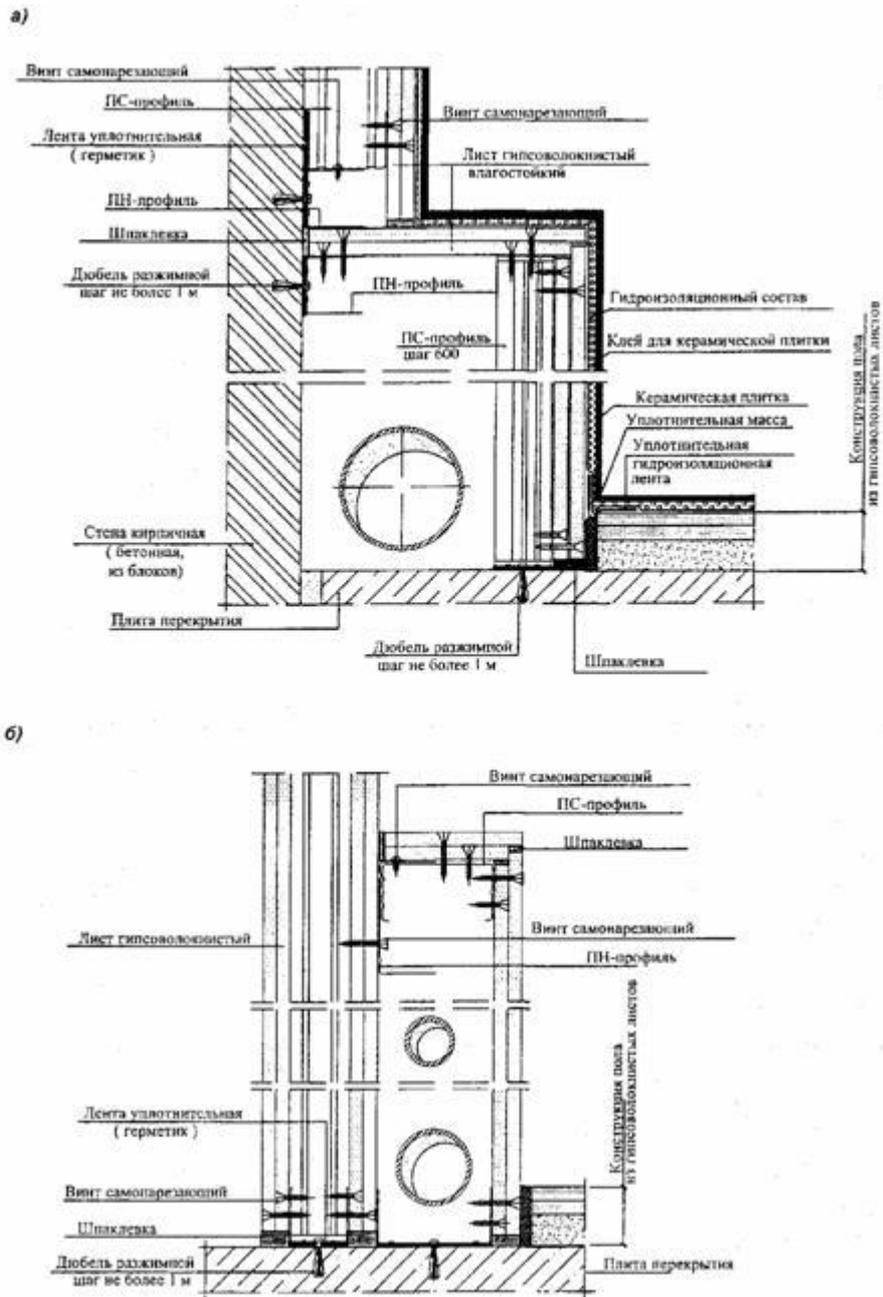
Конструктивное решение оформления трубопроводов, размещенных вдоль капитальной стены (а), перегородки (б)
